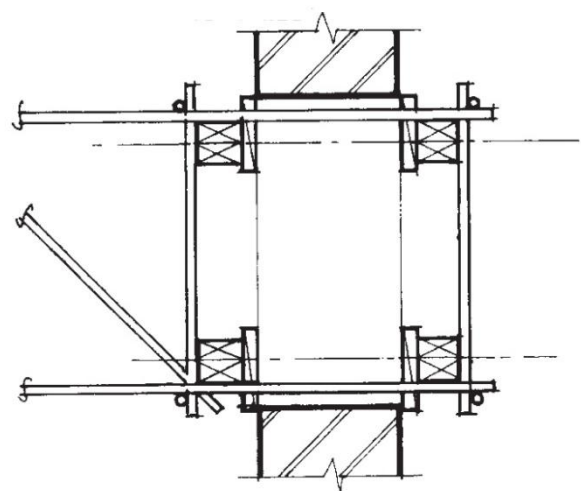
Pormenor de ligação de uma estrutura aérea à fachada, adaptado de [3].
